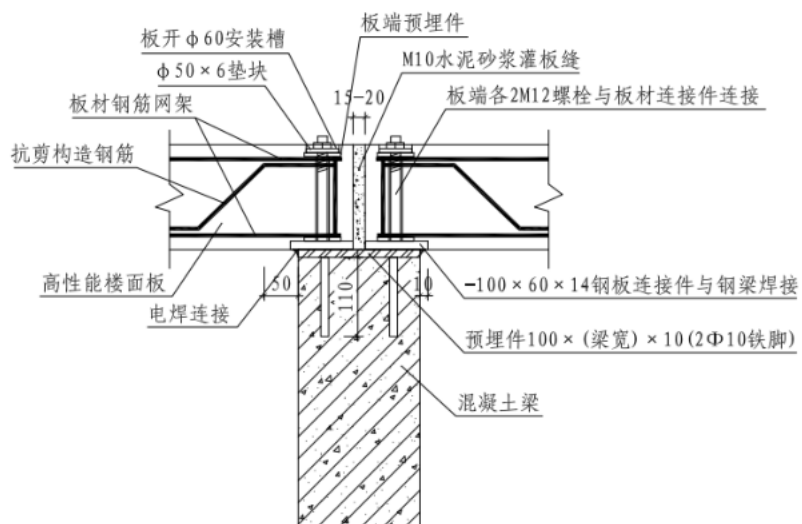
1 楼面板抗震支座混凝土梁连接构造（一）
